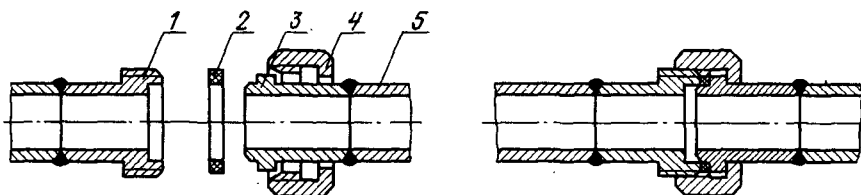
Соединение до сборки (а) и после сборки (б) стальных труб на приварных соединительных гайках:
